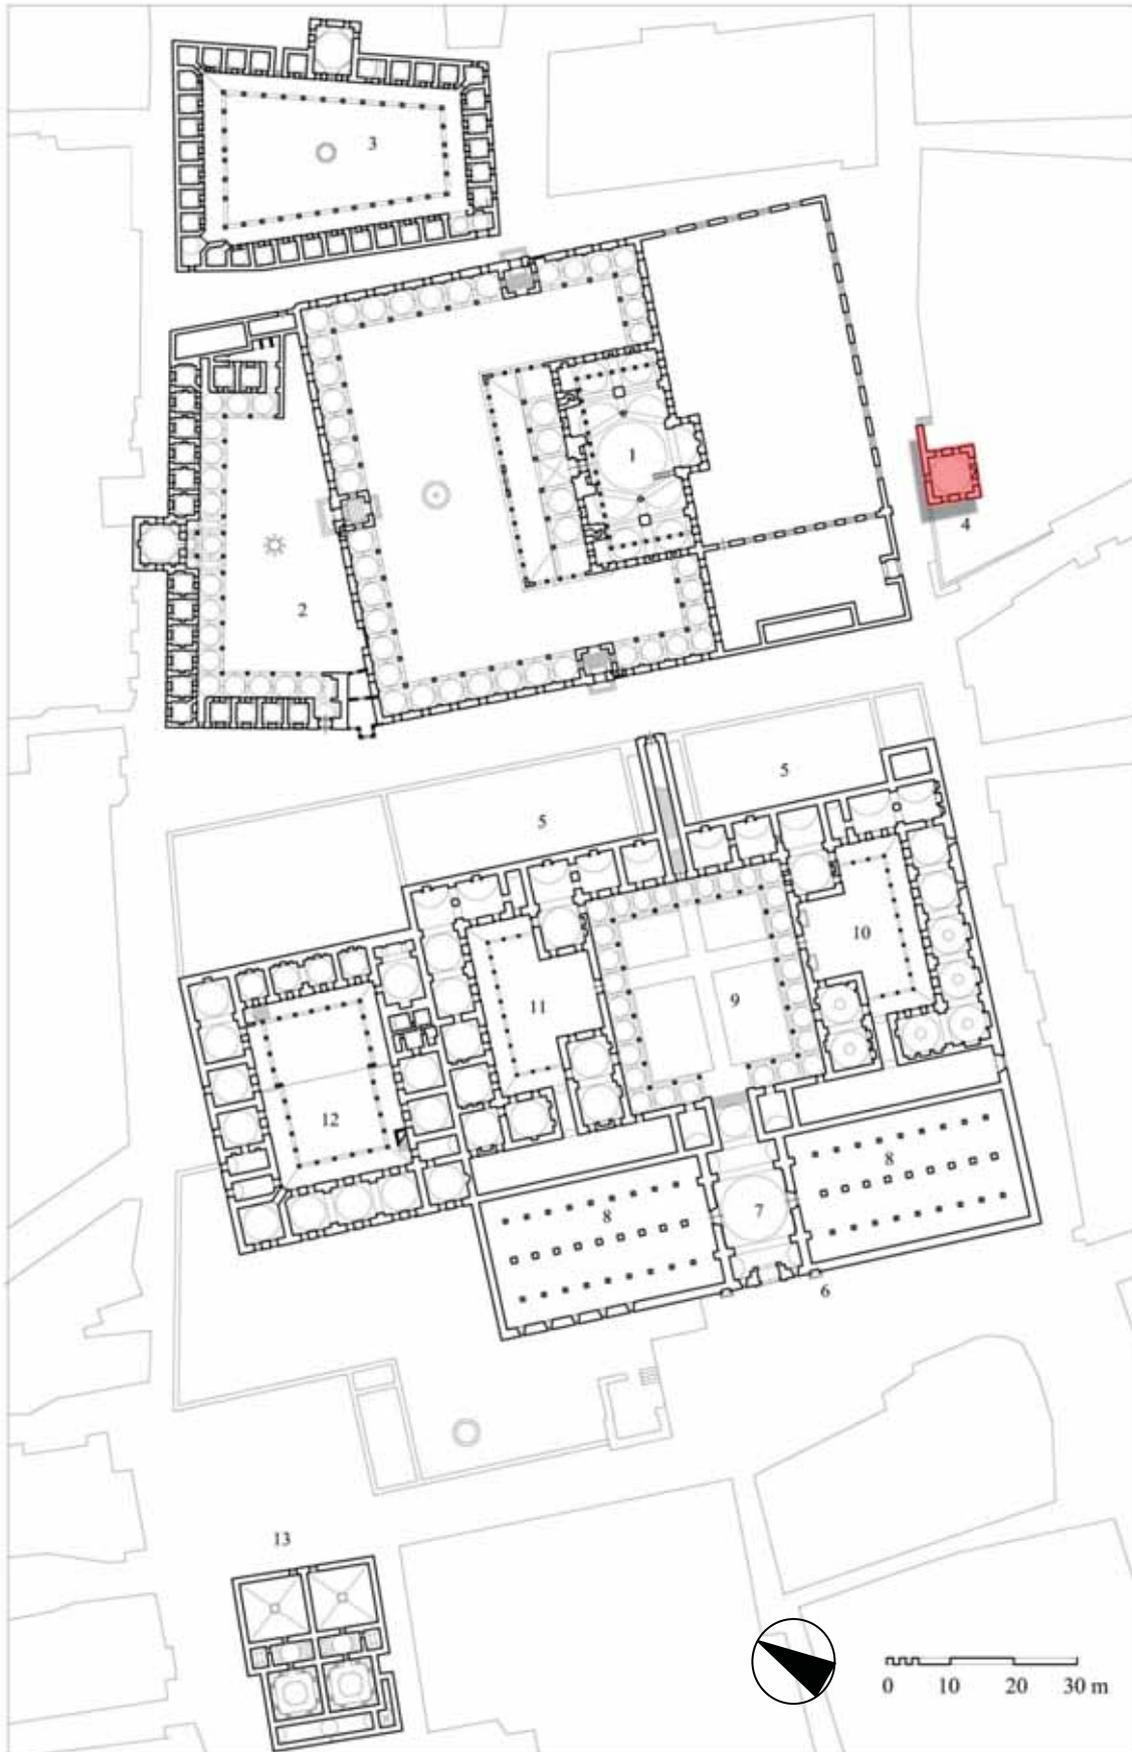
Grundriss und Lageplan der Schule (Sibyan Mektebi)
